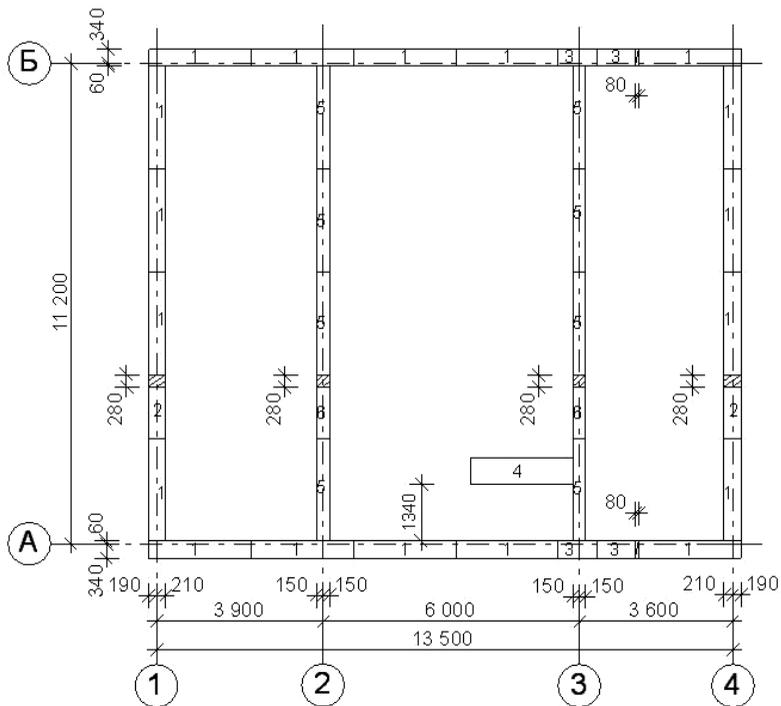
Раскладка 1-го ряда фундаментных блоков
